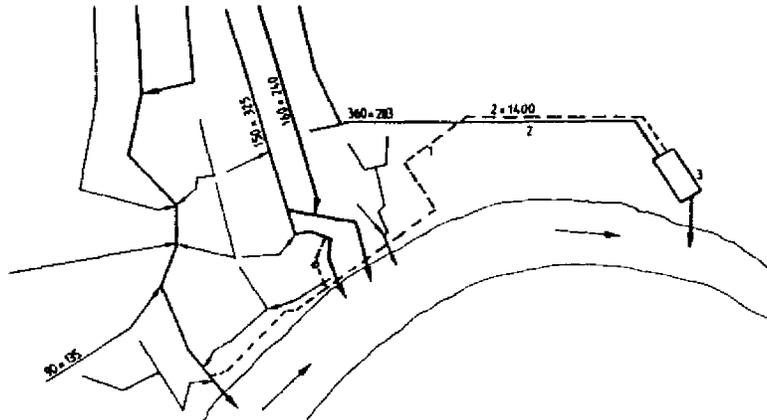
2: Plan para expandir la capacidad de un sistema de alcantarillado mediante una alcantarilla interceptora
